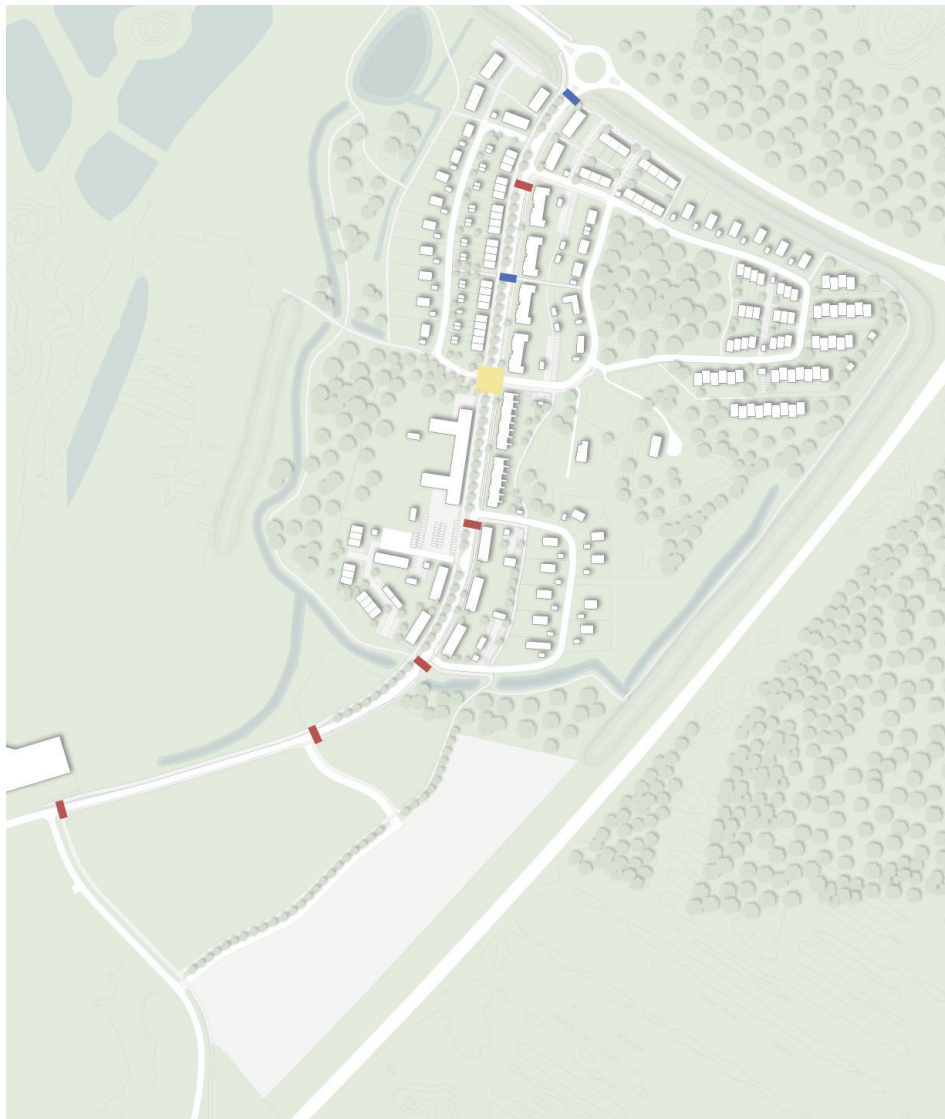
Placering av gång- och cykelpassager över Handelsvägen.
